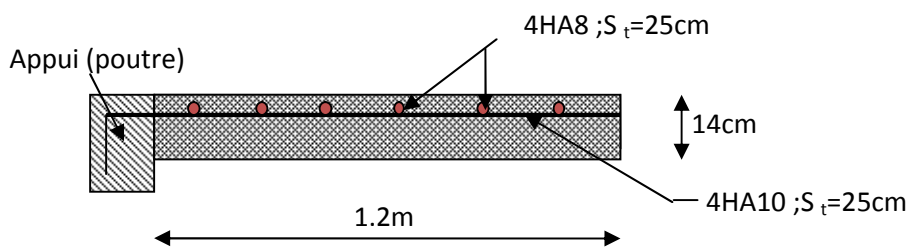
schéma de ferrailage de la dalle pleine sur 2 appuis
